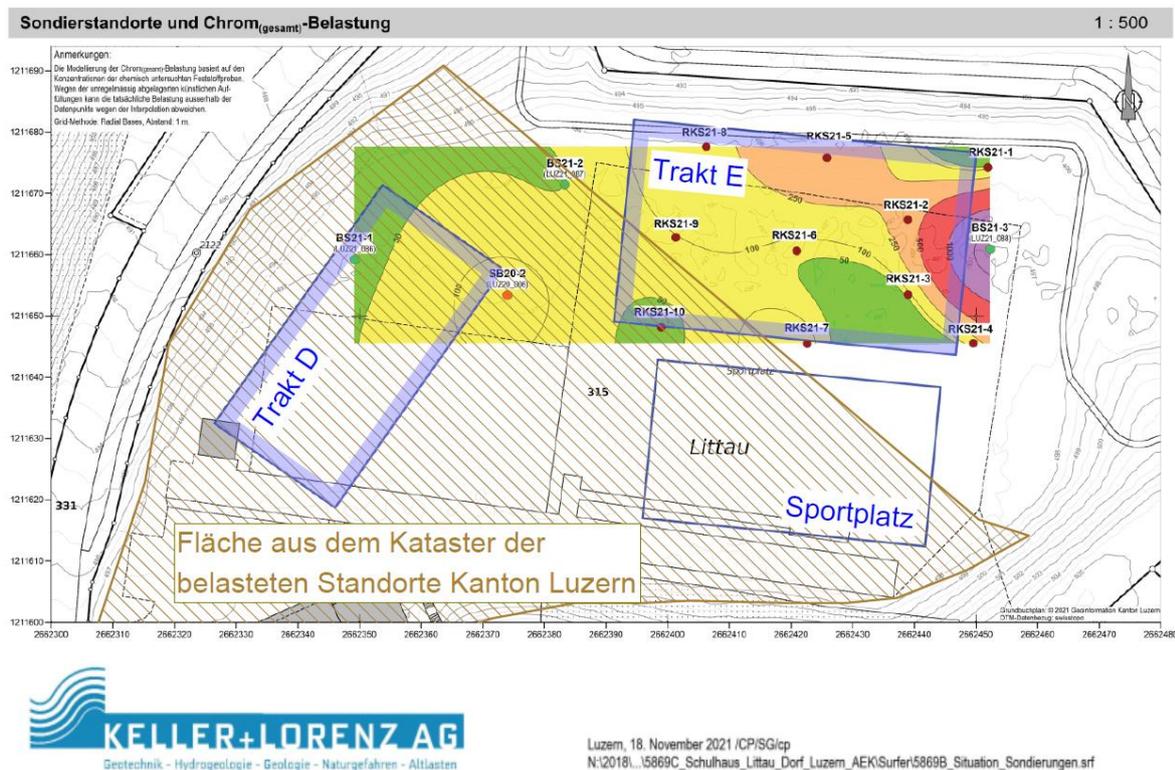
Übersicht Baugrunduntersuchungen mit Eintrag Altlastenkataster
